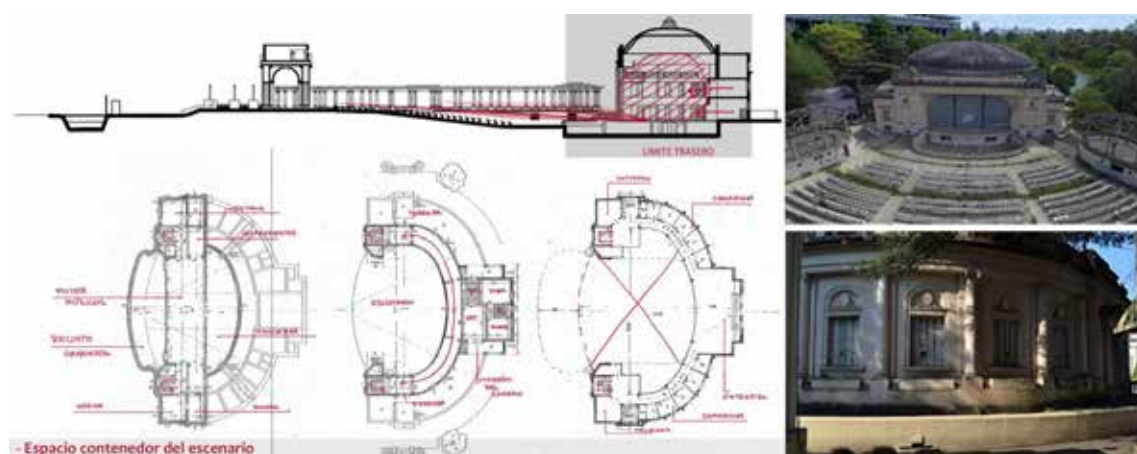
Espacio contenedor del escenario. Fuente: Elaboración propia. Imágenes tomadas en marzo de 2020. Planos de planta facilitados por el Archivo del Ministerio de Infraestructura de la Prov. de Bs.As.
